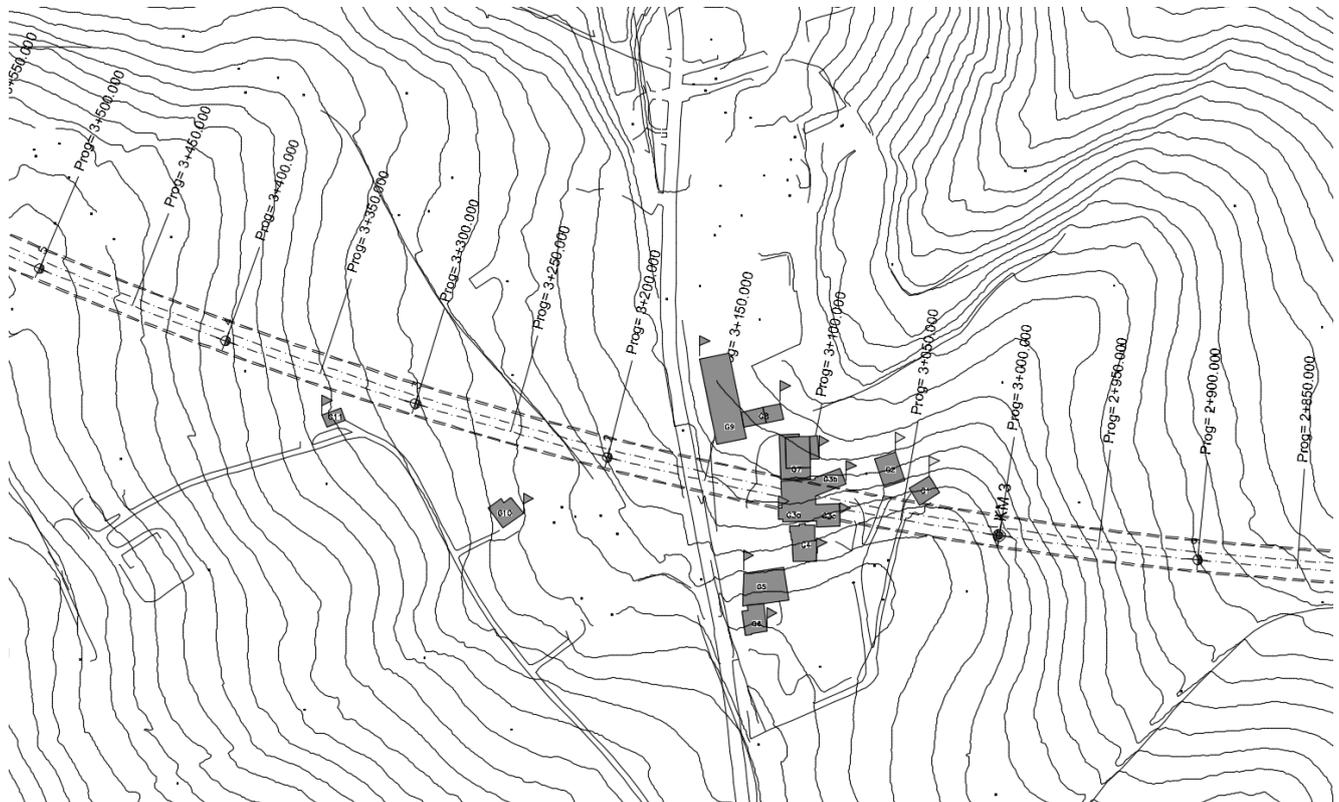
Planimetria posizione edifici zona galleria galleria Grottaminarda
